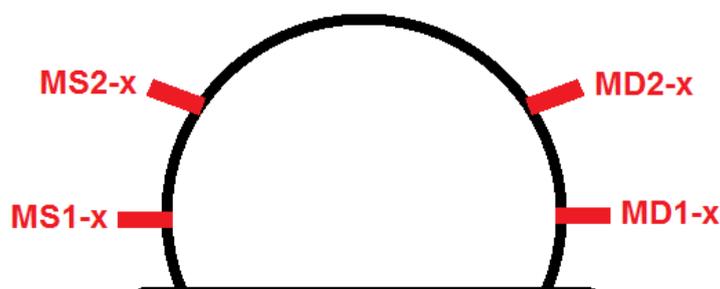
Posizione dei martinetti piatti nella sezione della galleria
